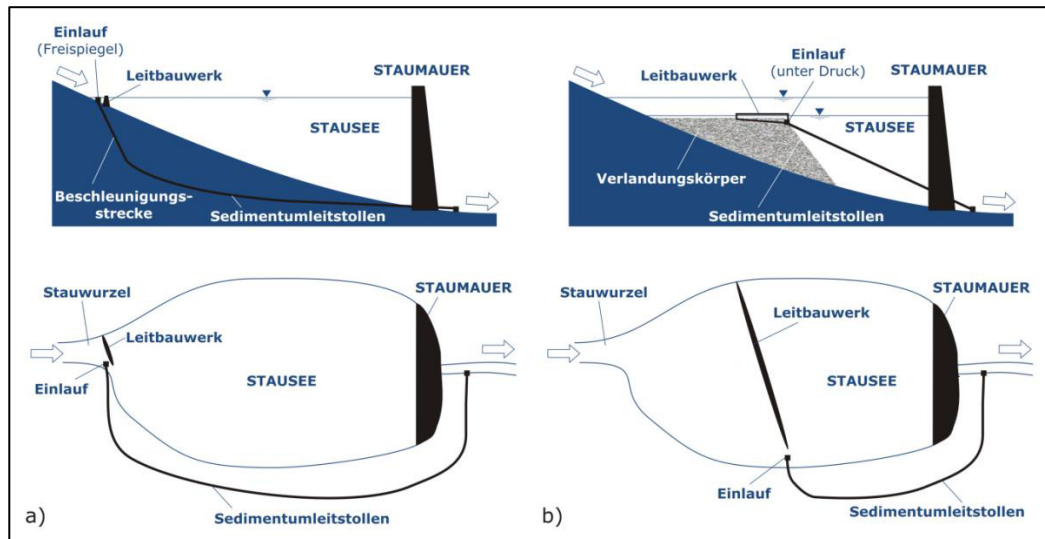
Schematische Darstellung eines Sedimentumleitstollens (nach Boes, 2011). Einlaufbauwerk a) an der Stauwurzel und b) im Stauee; Längsschnitt (oben) und Grundriss (unten).
